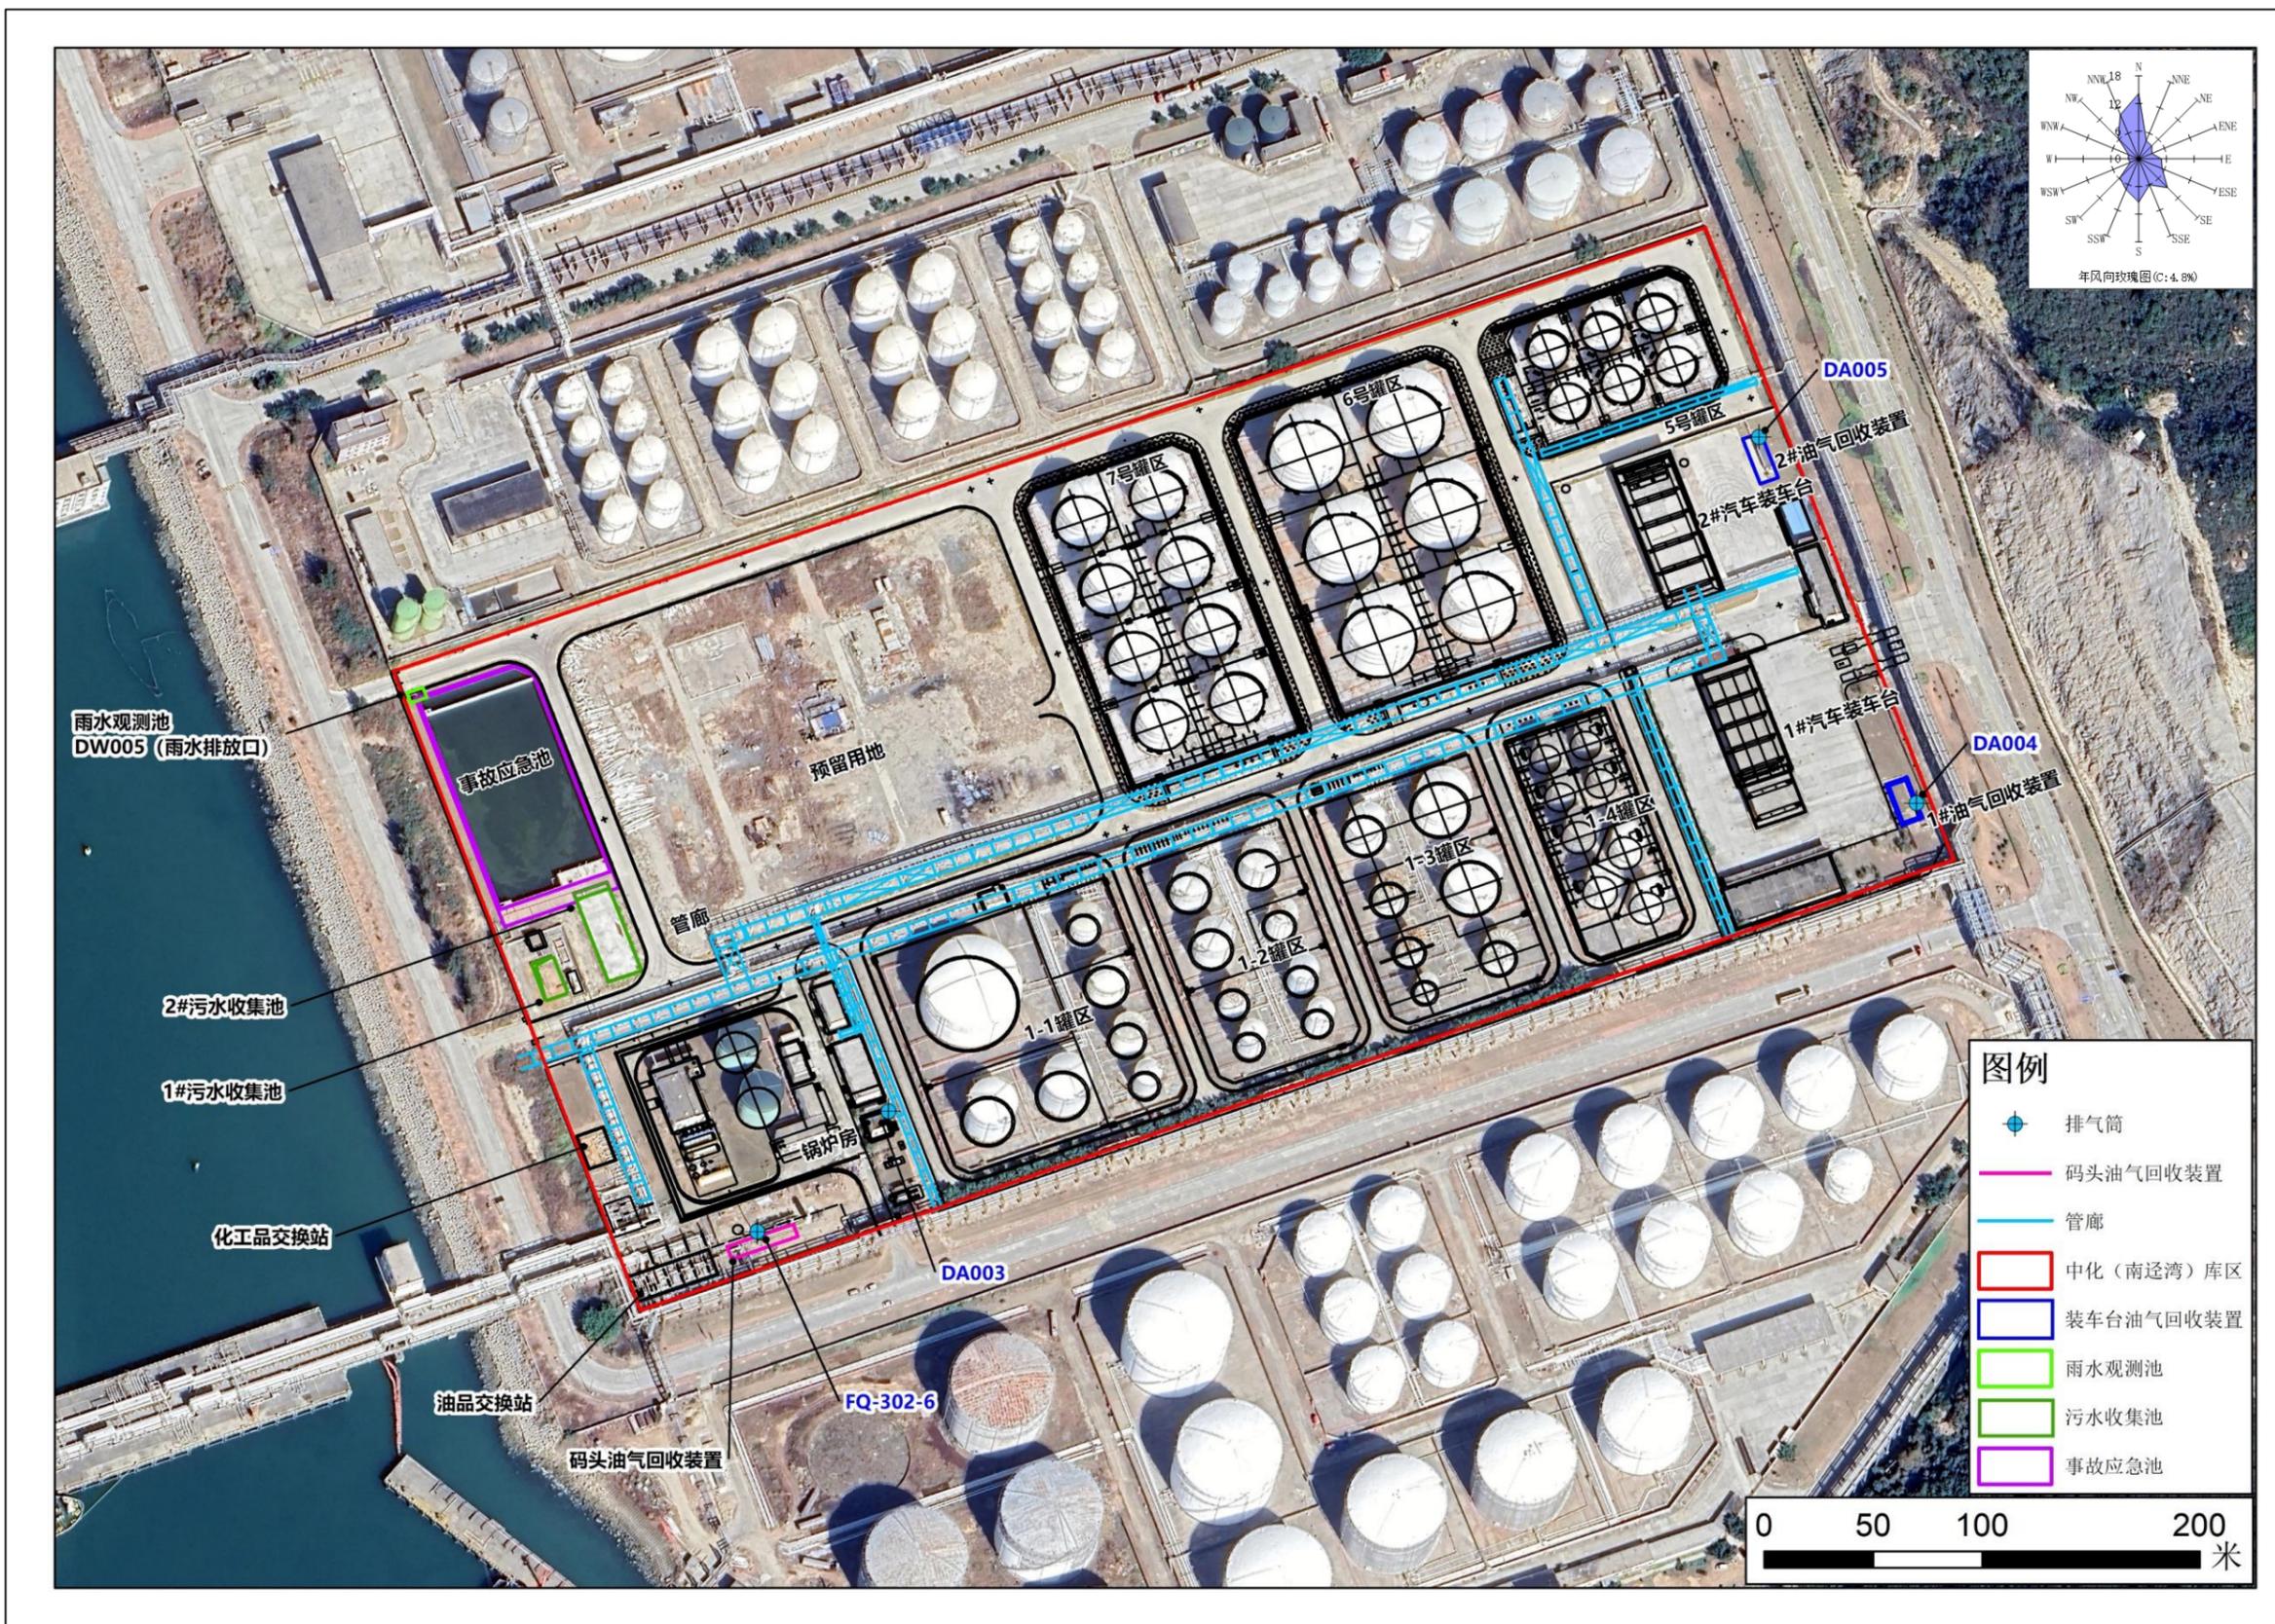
项目总平面布置图 (实际建设与登记备案阶段一致)
